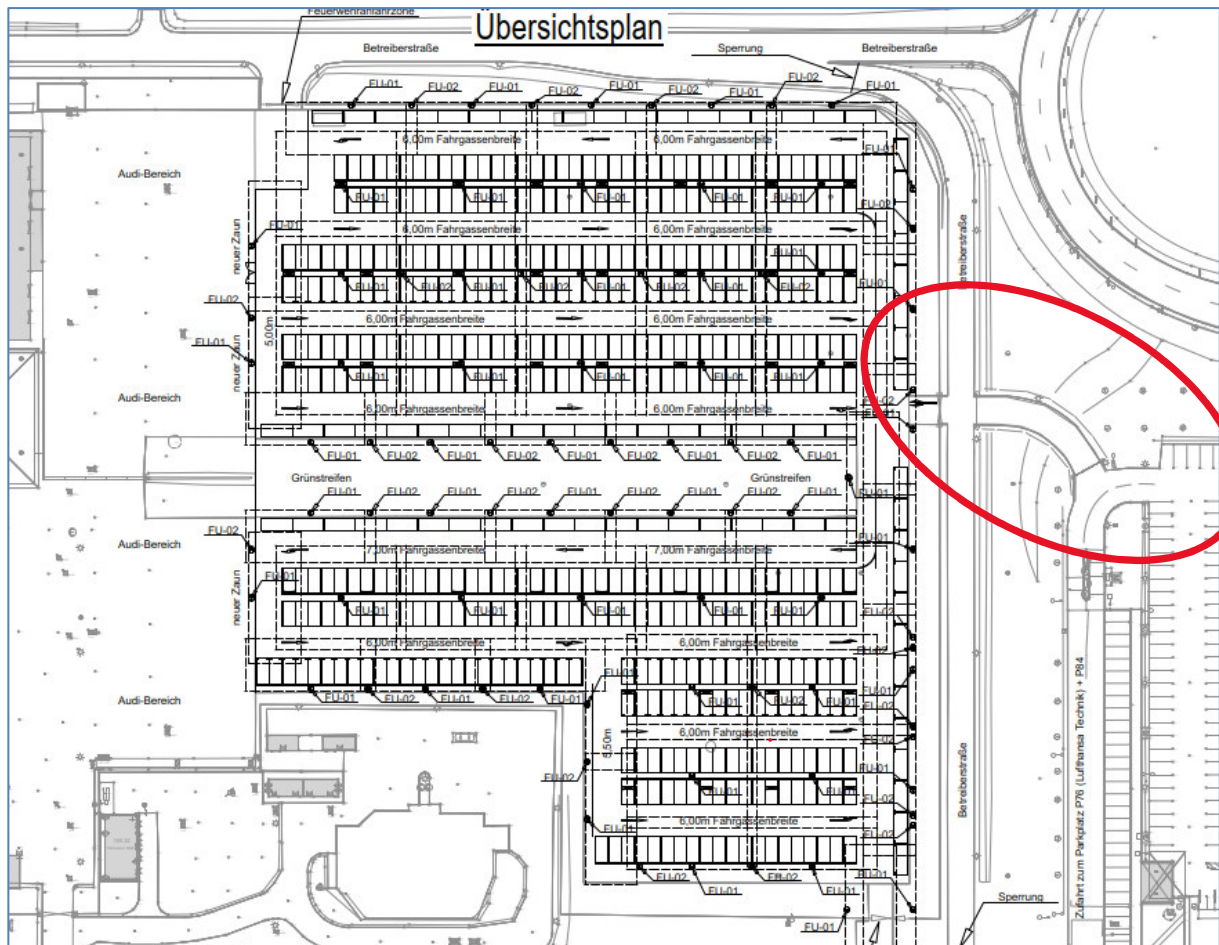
Parkplatz P84 mit Anbindung P76 östlich der Betriebsstraße.
